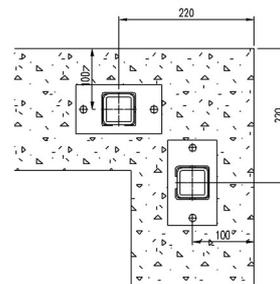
Draufsicht der Position der Pfosten für die horizontale Befestigung
